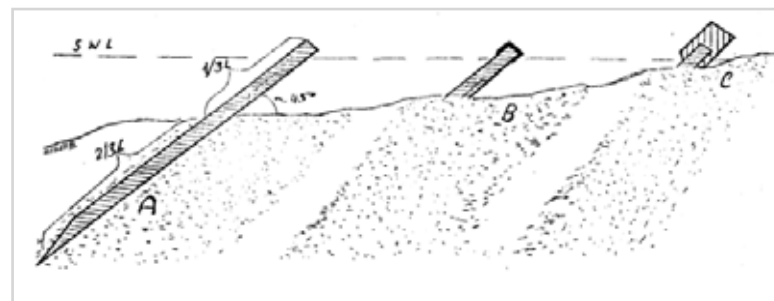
Usytuowanie elementów BET-CHRON I w strefie przybrzeżnej morza w ramach proponowanego układu ochraniającego brzeg FALOCHRON-KOMPLEKS
